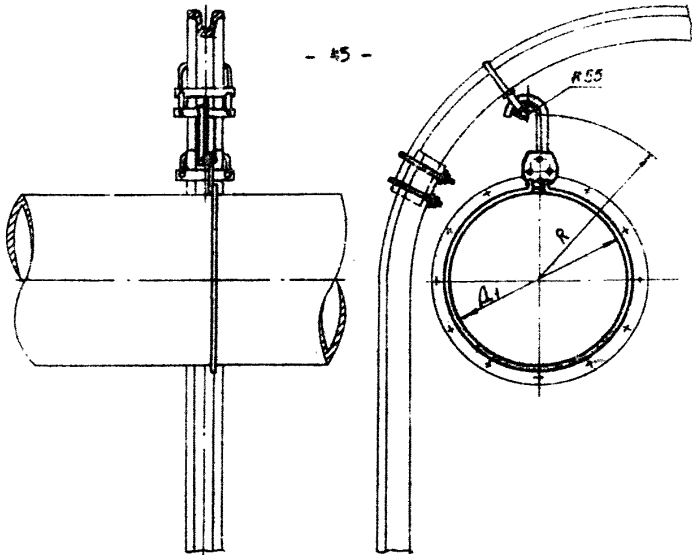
Подвеска для вентиляционных металлических трубопроводов к твинговой креплению вертикальных стволов
